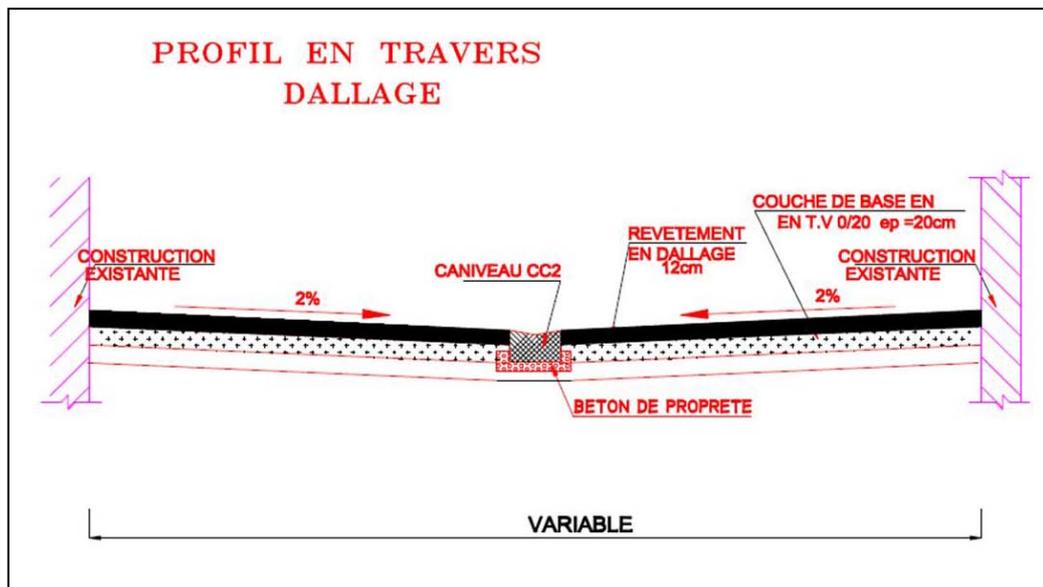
Coupe type du corps de chaussée type voie en dallage (Aménagement type-1)
